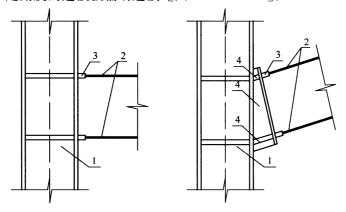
型钢柱与钢筋套筒的连接方式 1一柱内型钢; 2一角焊缝; 3一可焊钢筋连接套筒; 4一辅助加劲板
